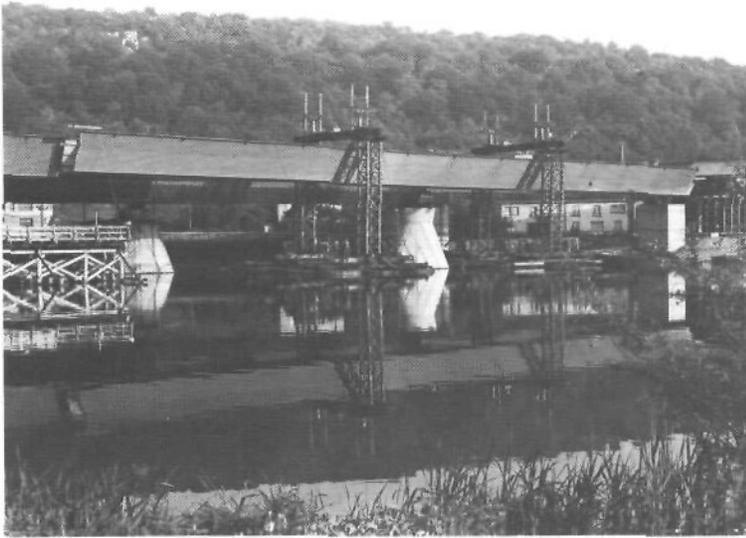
Le tronçon a été entièrement assemblé sur berge.
